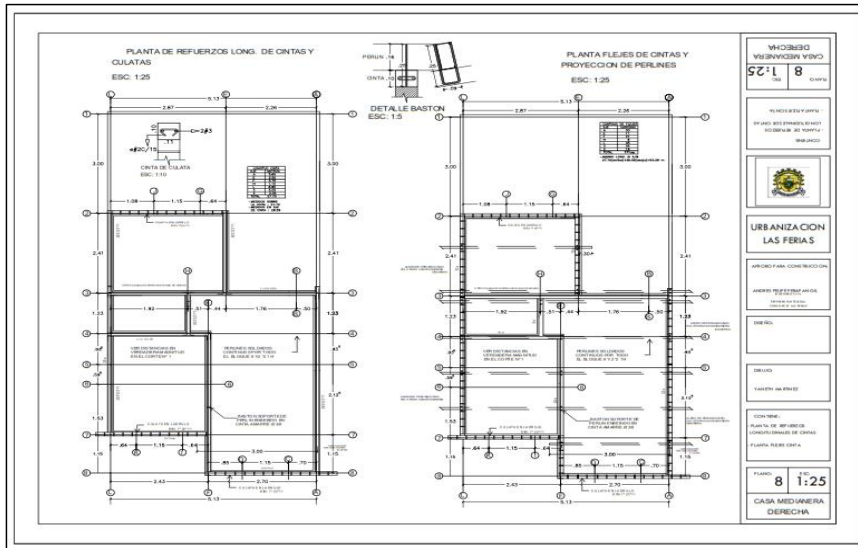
Planta de refuerzos longitudinales vigas aéreas.
